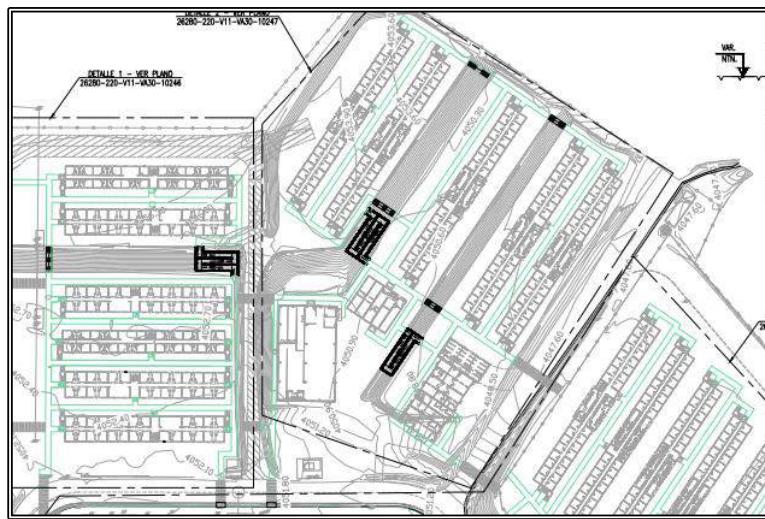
Vista en Planta Veredas, Escaleras y Rampas
